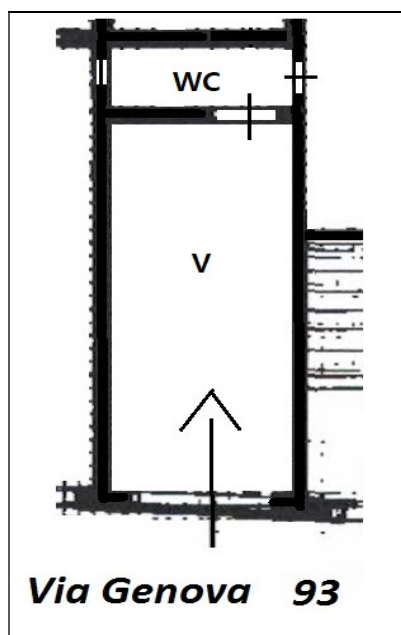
Rappresentazione planimetrica del locale al piano terra
